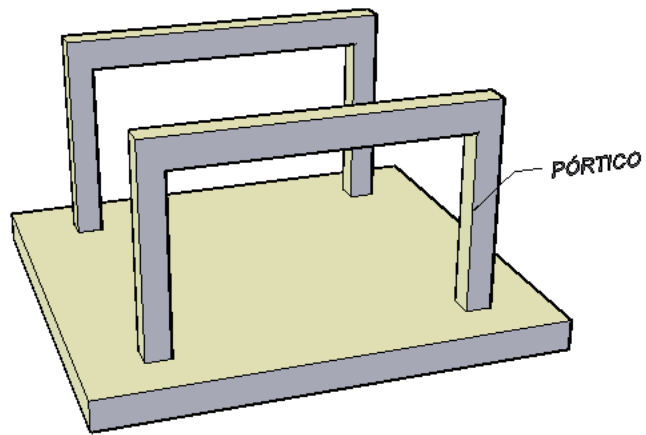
Nivelar los pórticos o muros que se apoyan las vigas.
